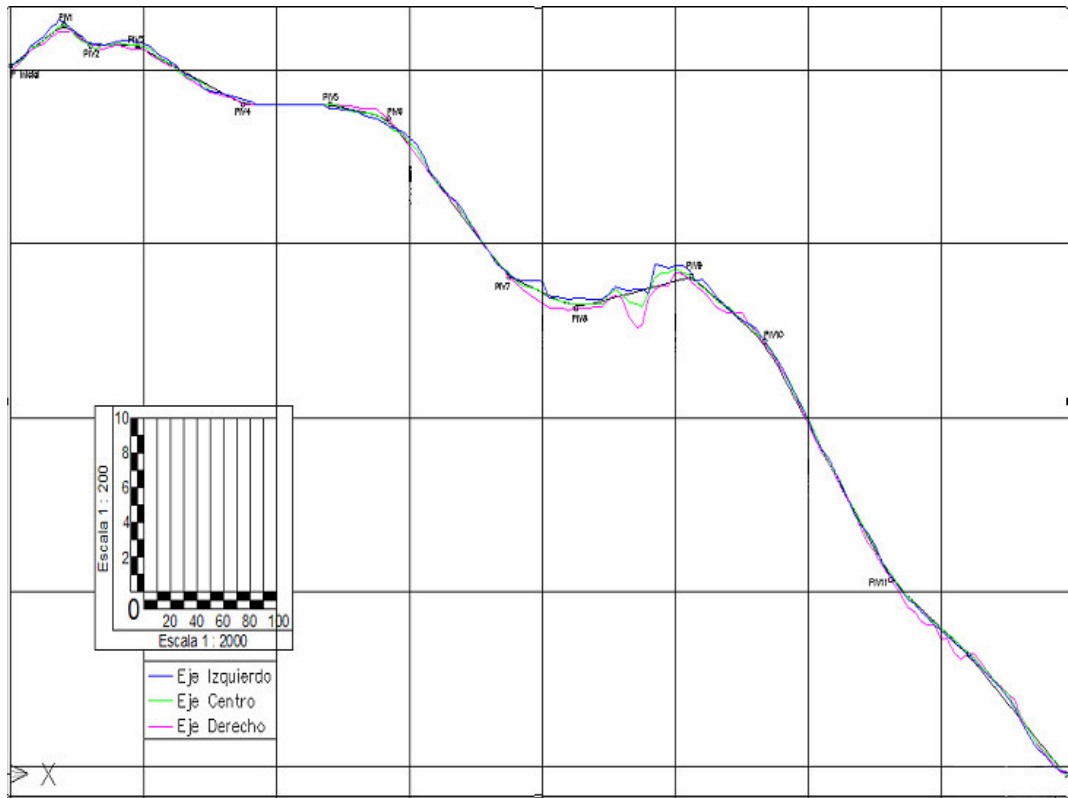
Diseño en perfil proyecto de pavimentación “San Ezequiel - Ancianato
